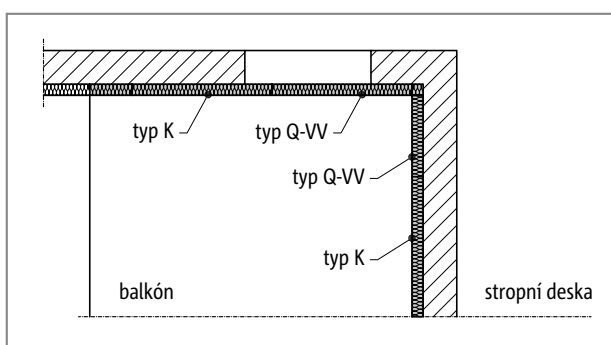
Schöck Isokorb® typ K: Volně vyložený balkón
